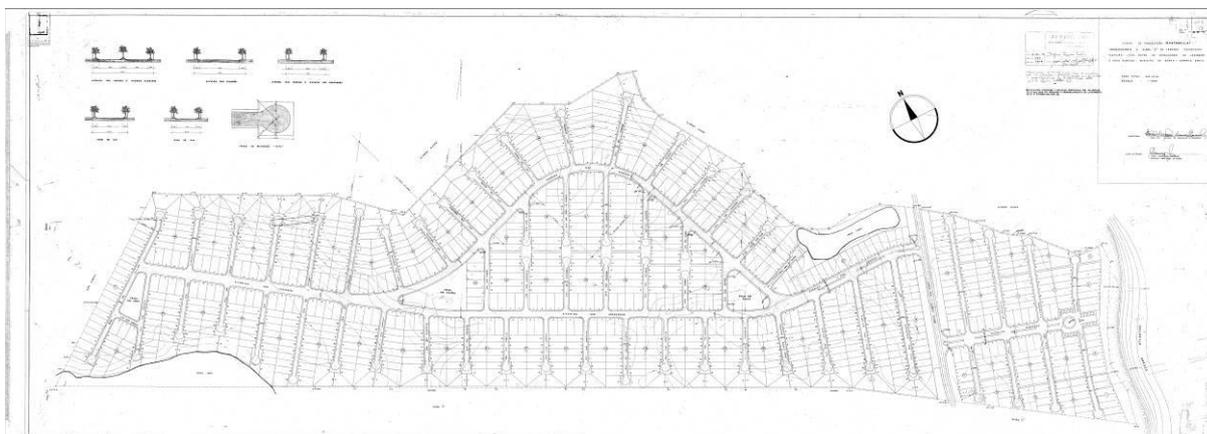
Planta do loteamento Nova Carapina I aprovado no ano de 1978.
